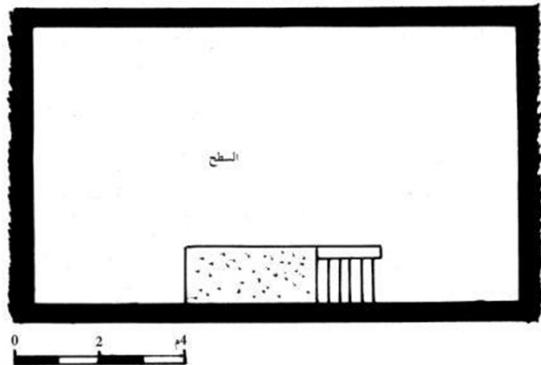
مسقط أفقي للطابق العلوي لنفس الدار
